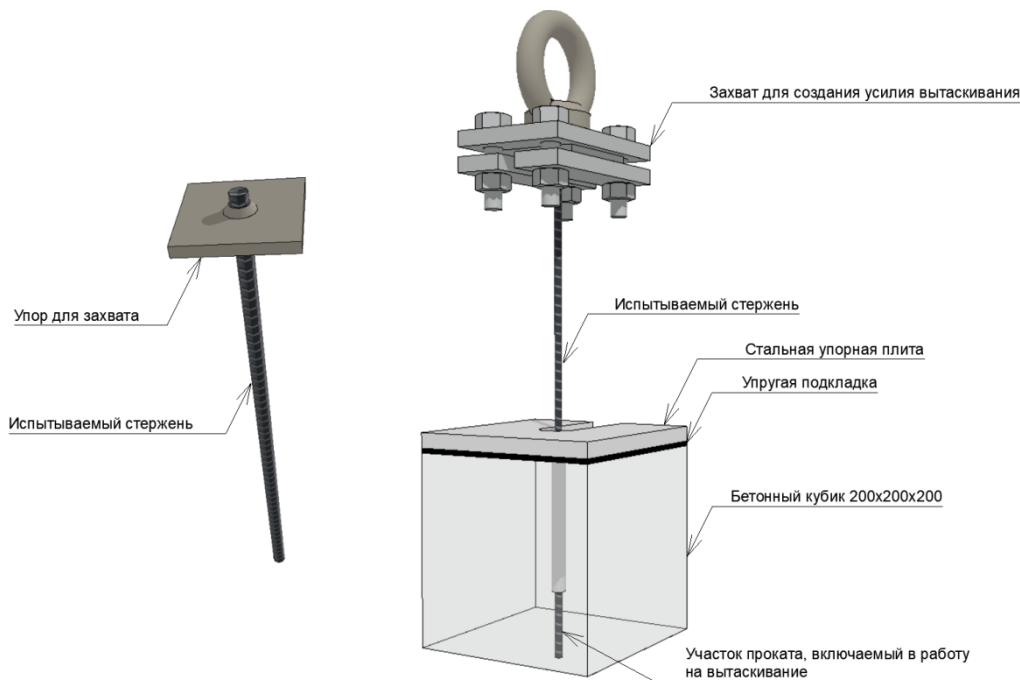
Испытание стальной арматуры периодического профиля на вытаскивание по ГОСТ Р 57357- 2016 (слева – образец проката (арматурного элемента) для испытаний на вытаскивание, справа – принципиальная схема установки для производства испытаний проката на вытаскивание)
